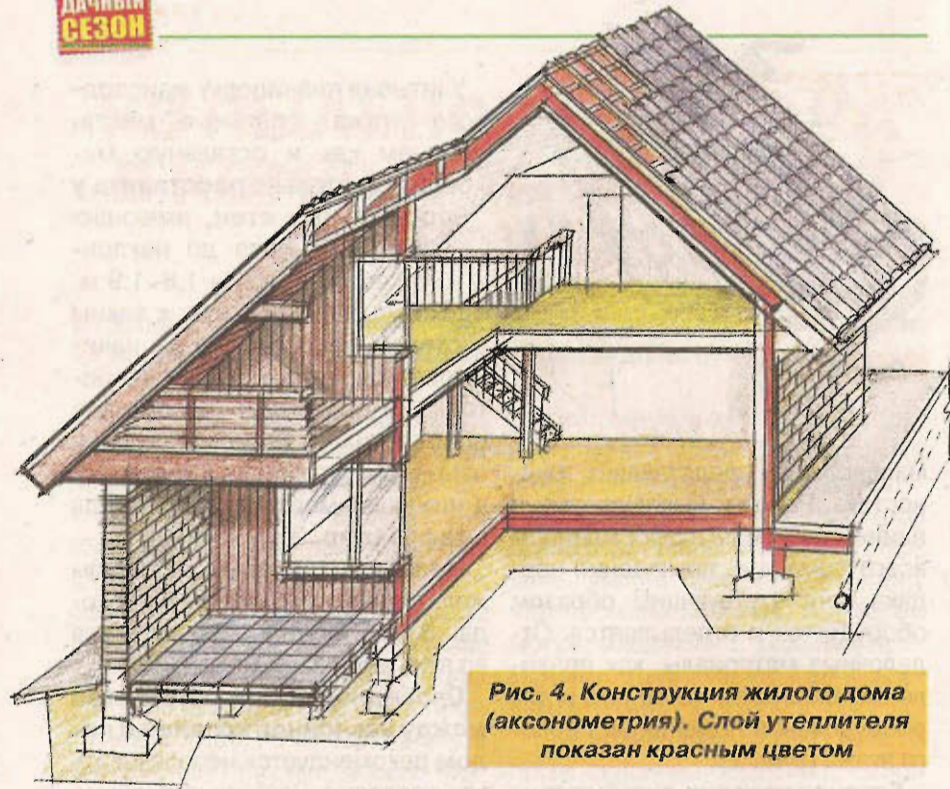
Конструкция жилого дома (аксонометрия). Слой утеплителя показан красным цветом
